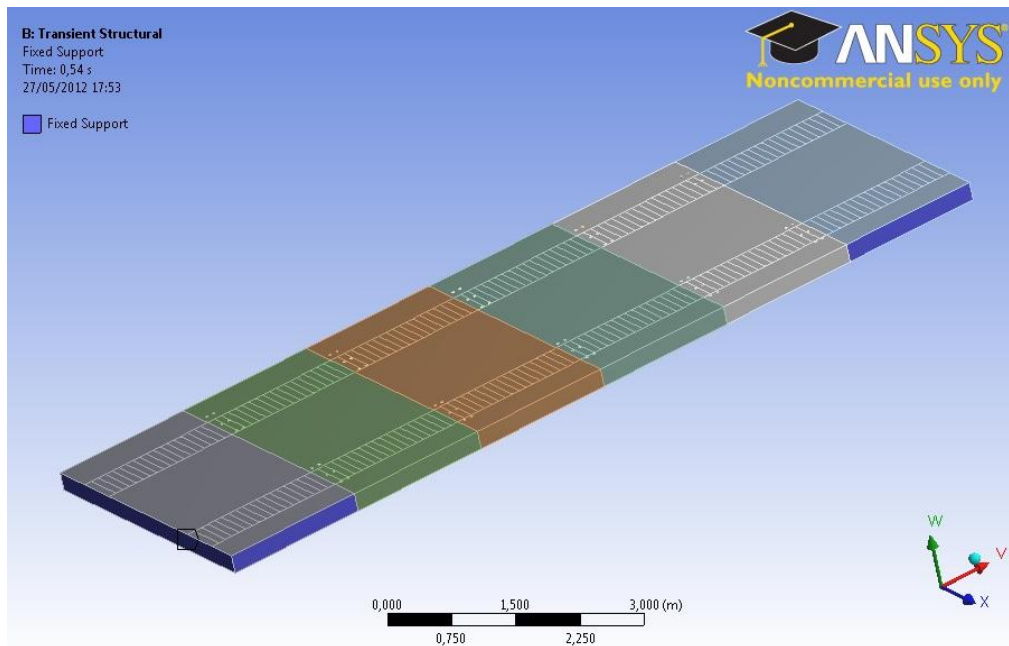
Soporte de tipo fixed en bordes de losas correspondientes al pavimento existente.
